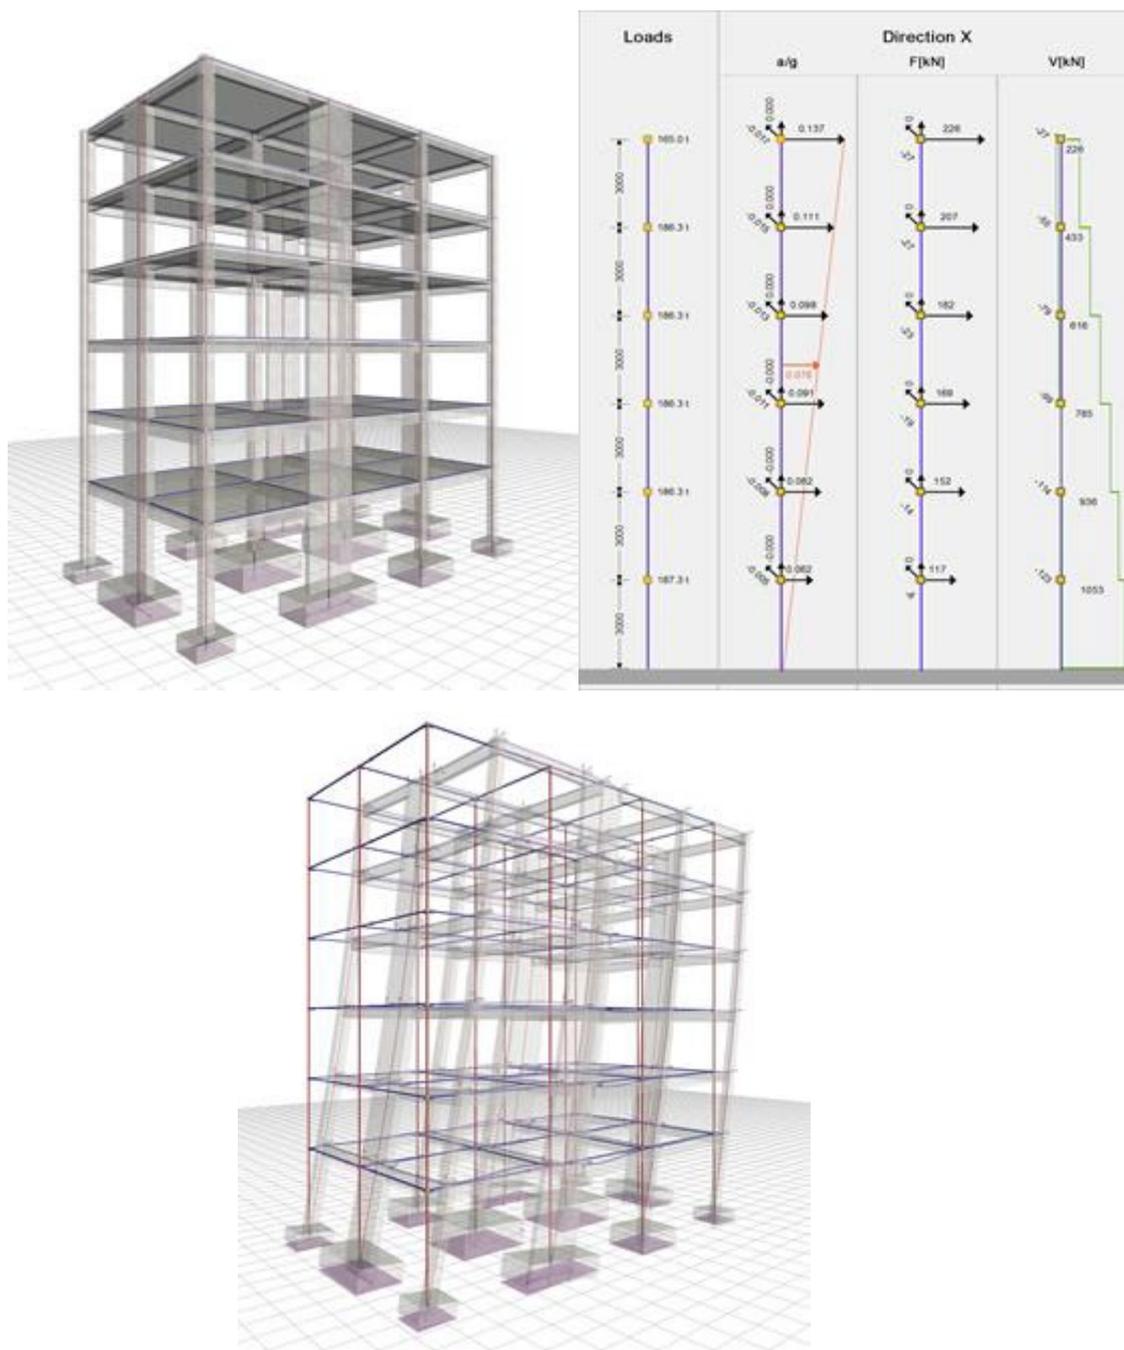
Конструктивна схема будівлі з несучим каркасом і стінами, що спираються на стовпчастий фундамент
